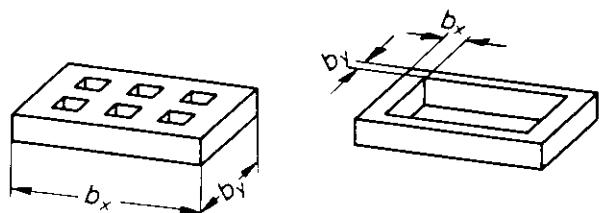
Maßgebende Breiten für den Grundbruchnachweis bei durchbrochenen Fundamentgrundrissen
